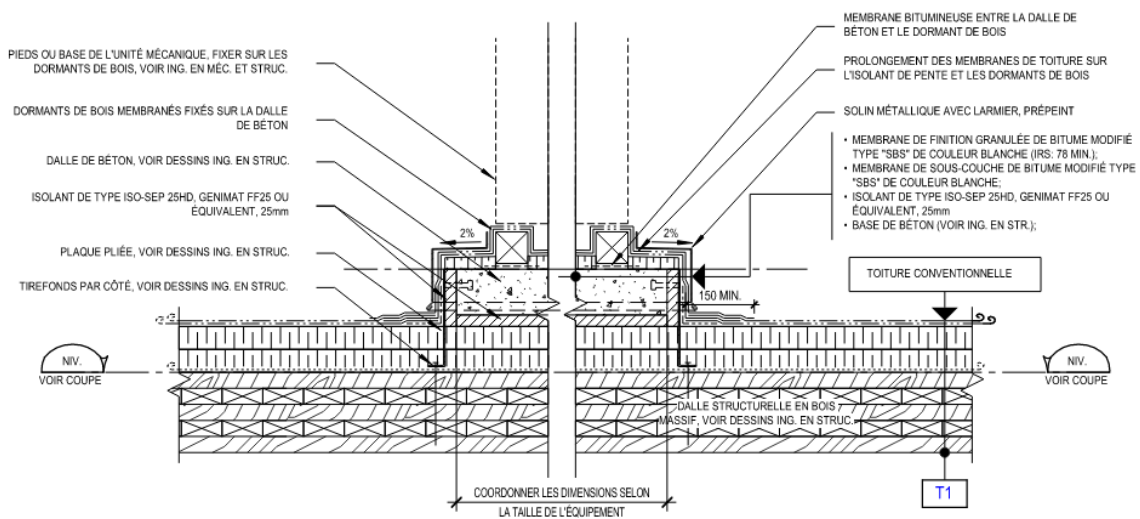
Dalle isolée au toit pour équipements mécaniques
